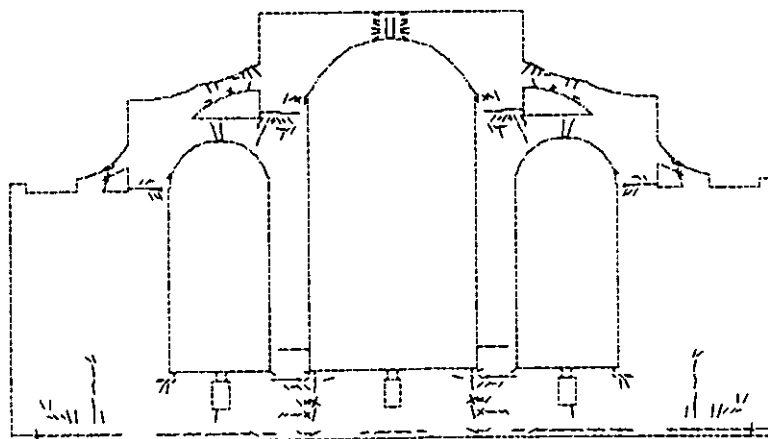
Configuración de grietas por levantamiento parabólico en la base
